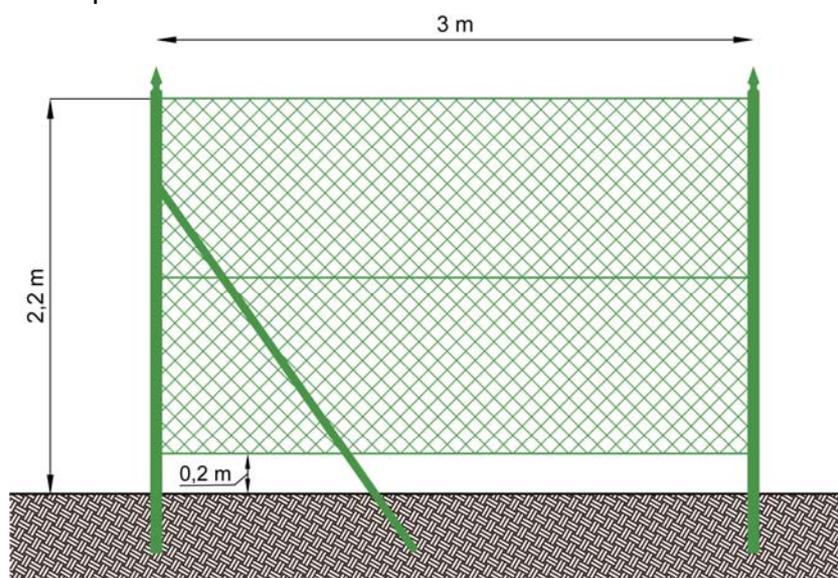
Particolare della recinzione di cui è prevista l'installazione
